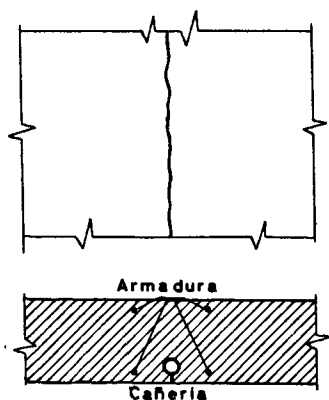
Grieta en un muro armado provocada por la expansión de una cañería de calefacción. Obsérvese la semejanza con las grietas de corrosión de armaduras.
